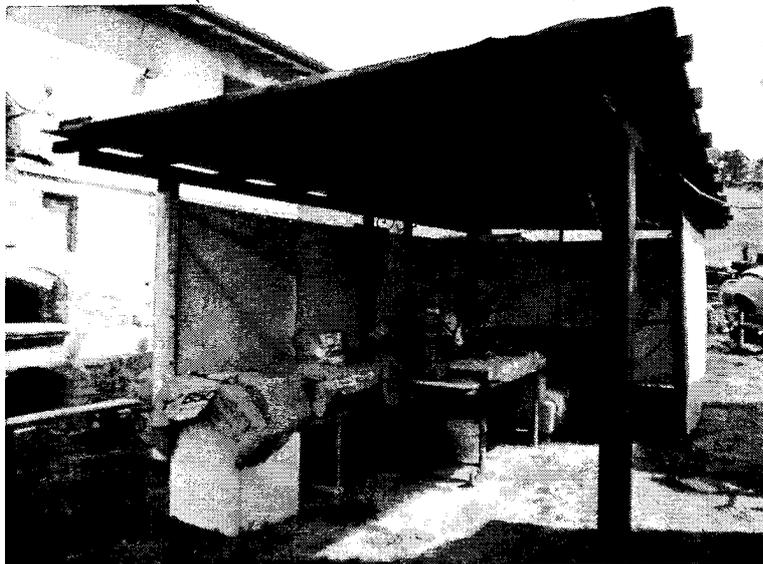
veduta verso Est (parete del Fabbricato - Lato Nord)
